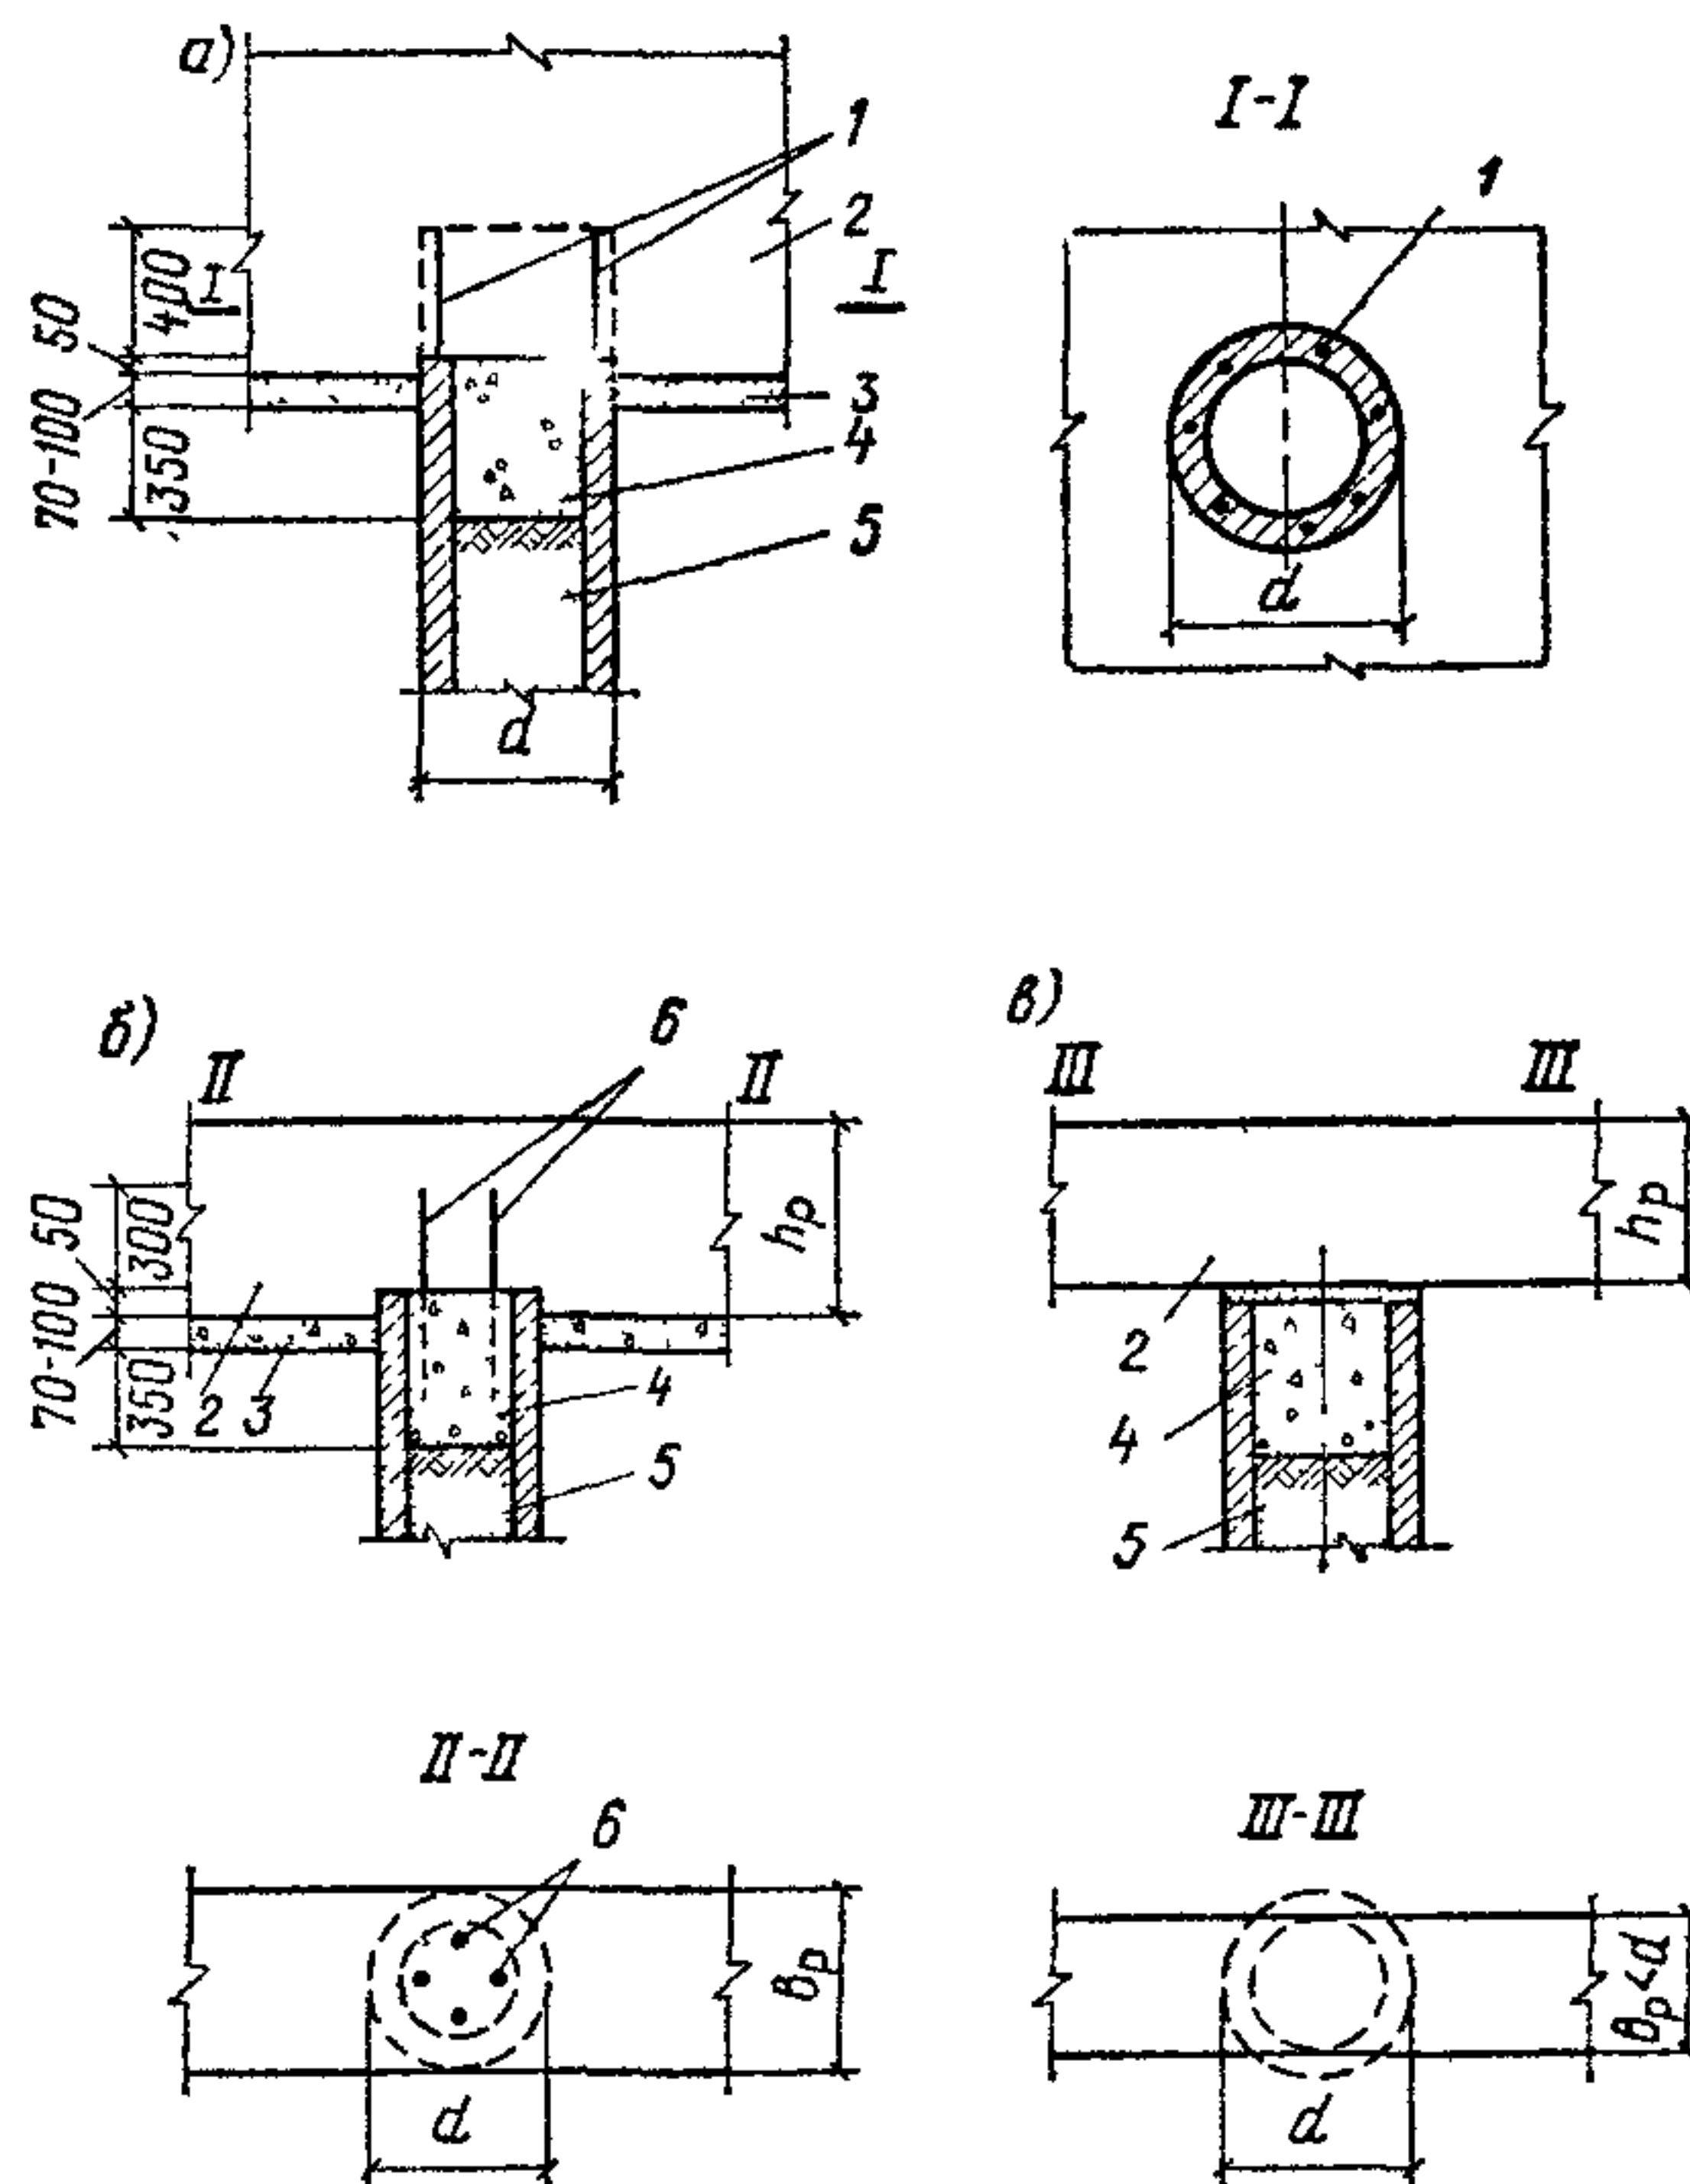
Примеры конструктивного решения сопряжения железобетонных полых круглых свай диаметром 300—800 мм, работающих на нормальные сжимающие усилия, не выходящие за пределы ядра сечения свай, с железобетонными ростверками а — сопряжение с монолитными кустовыми или ленточными ростверками при недобивке свай до проектной отметки; б — сопряжения с монолитными ленточными ростверками при погружении свай до проектной отметки; в — свободное сопряжение с монолитным железобетонным ростверком: 1 — продольная арматура свай; 2 — монолитный железобетонный ростверк; 3 — бетонная подготовка; 4 — бетонная пробка сверху свай; 5 — заполнение полости свай местным грунтом; 6 — дополнительные продольные арматурные стержни,  $d$  — наружный диаметр свай,  $h_p$  — высота ростверка;  $b_p$  — ширина ростверка, определяемая из расчета на местное сжатие (смятие) бетона стенок свай
